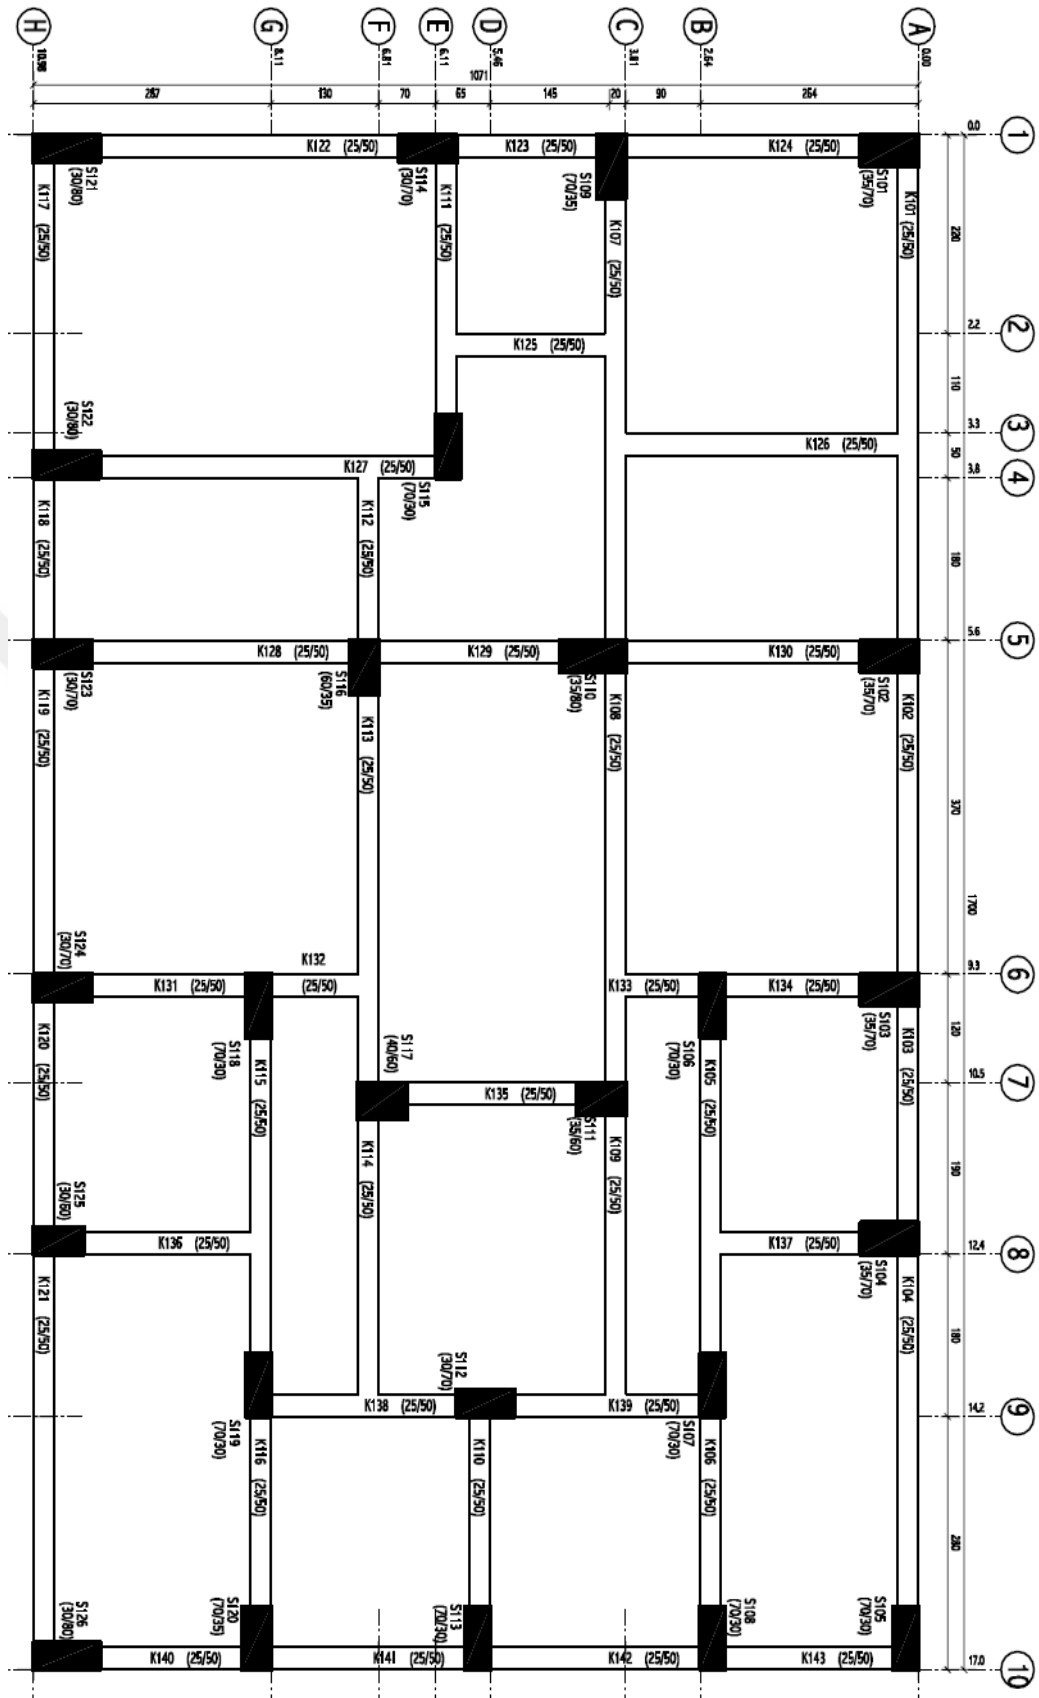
AFY-38 binasına ait kalıp planı (5 katlı)
